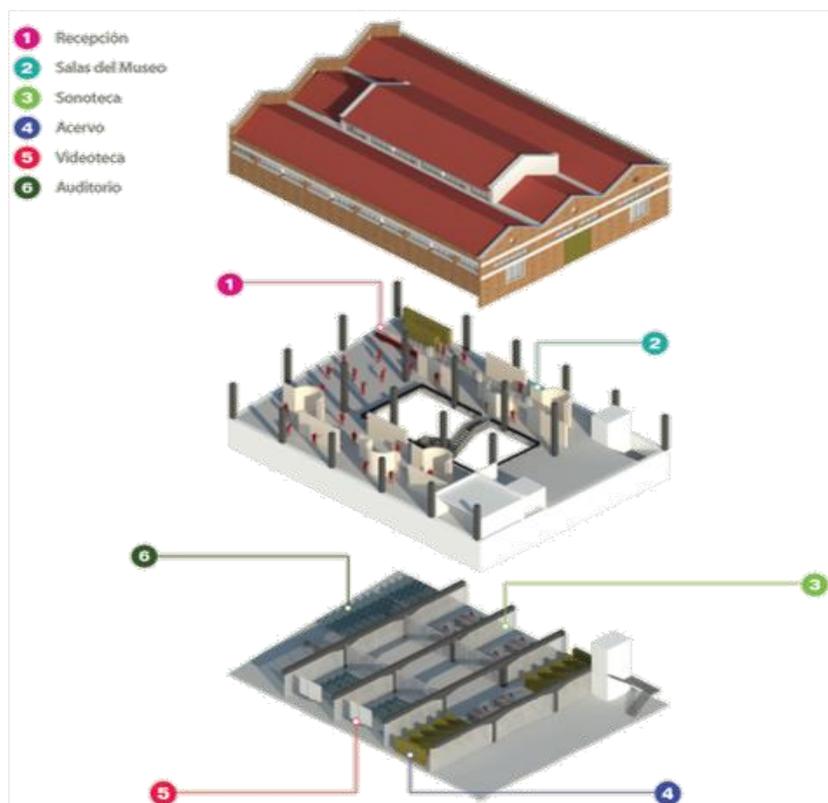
Planta primer nivel y sótano del Centro de Documentación. Fuente: Documento
